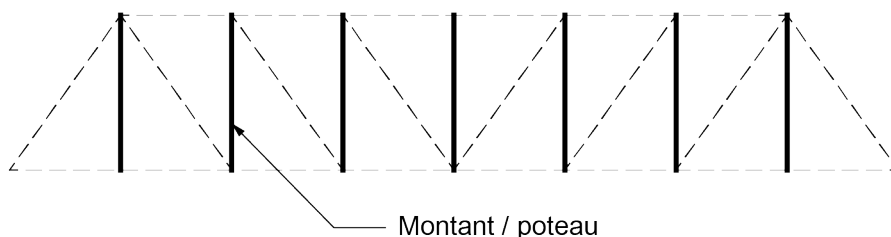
Montants / poteaux d'une poutre triangulée
